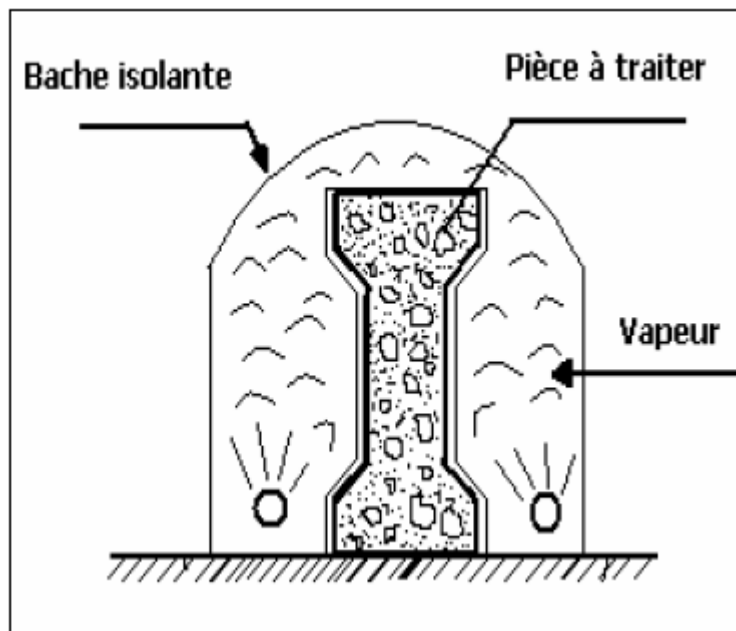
Chauffage d'une poutre sous bâche par vapeur d'eau perdu
